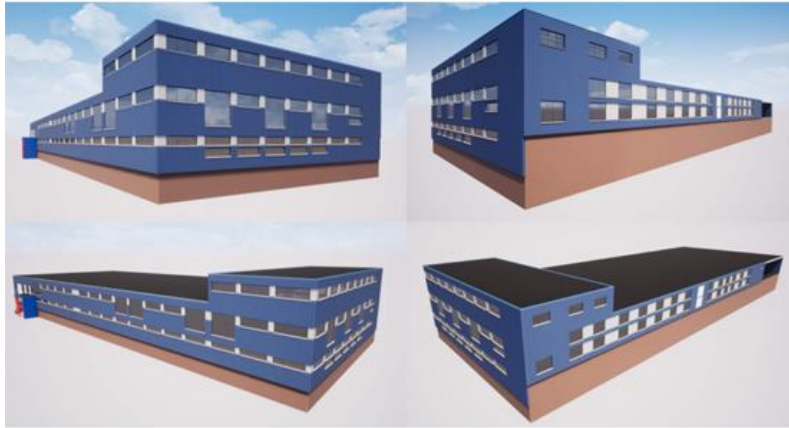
Projet de reconstruction d'un semi étage au second niveau
